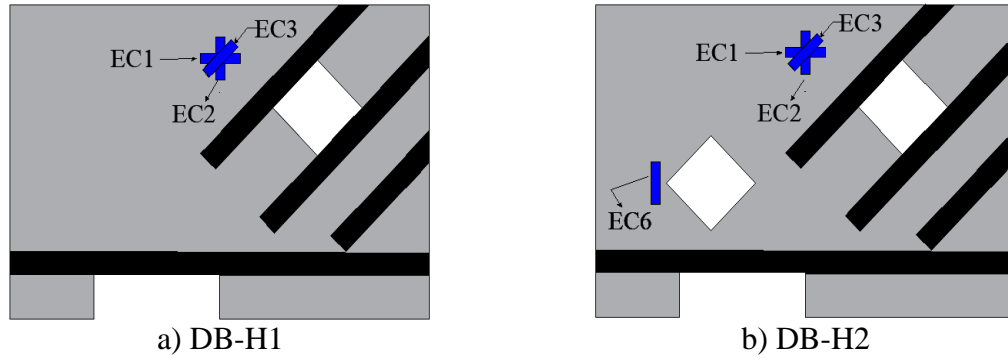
Posição dos extensômetros no concreto das vigas-parede reforçadas a flexão/cisalhamento
